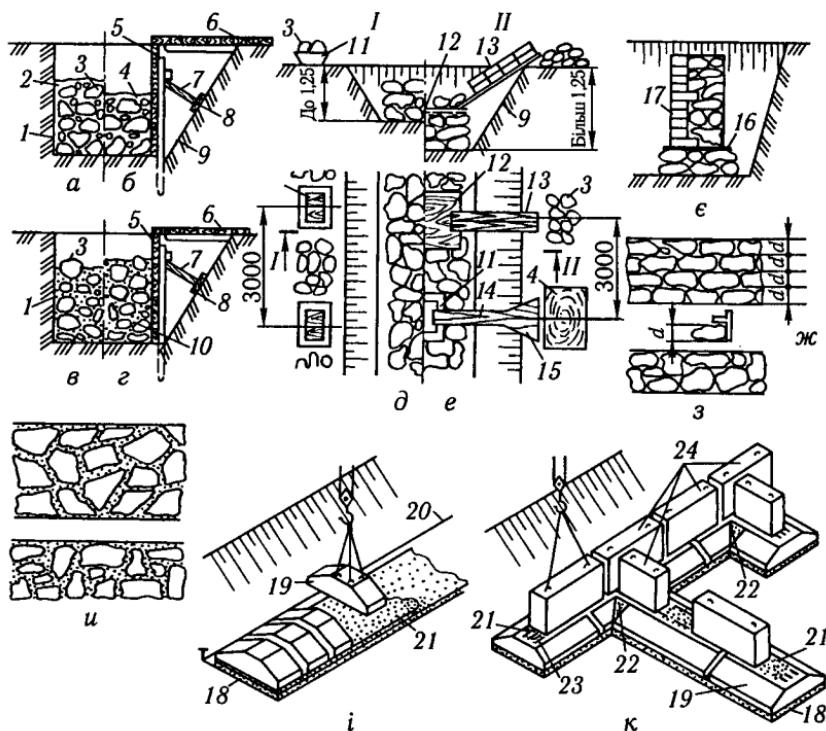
Зведення конструкцій підземної частини будівлі з бутового каменю і великих бетонних блоків:
